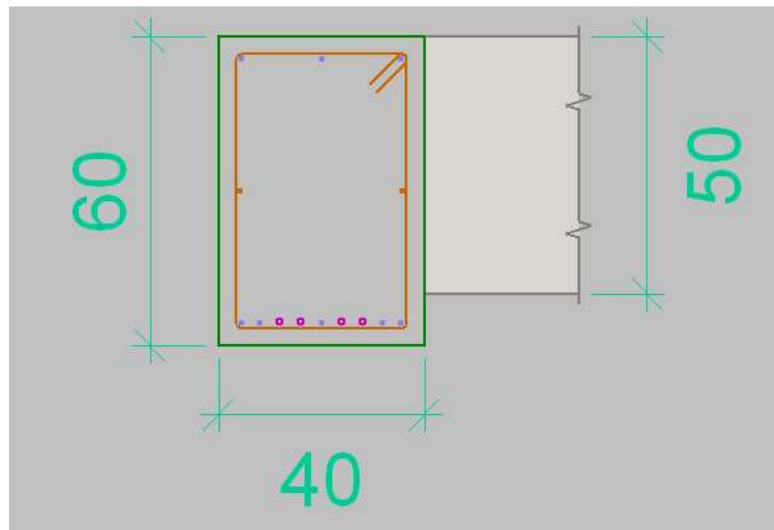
Secció de la biga ubicada entre els pilars P4 i P5 al Sostre de la Planta Baixa sense modificar el armats.
